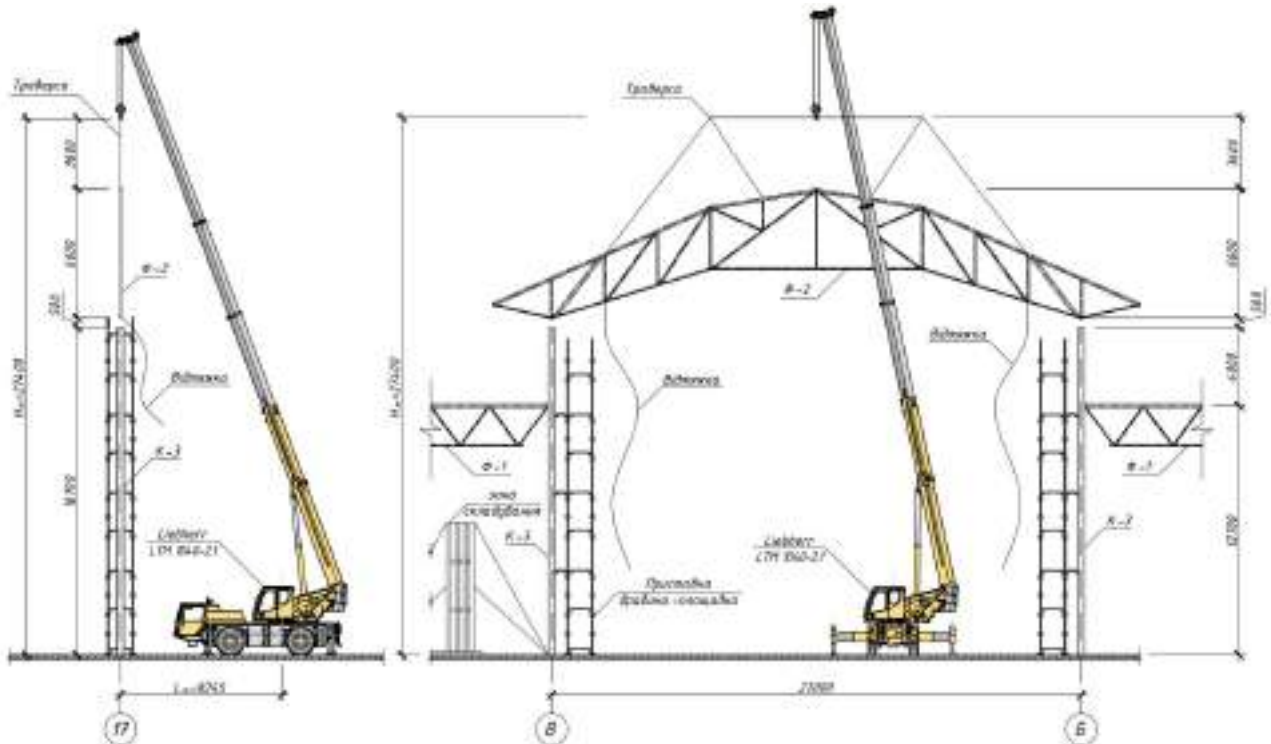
Розроблена схема монтажу крокв'яних ферм
